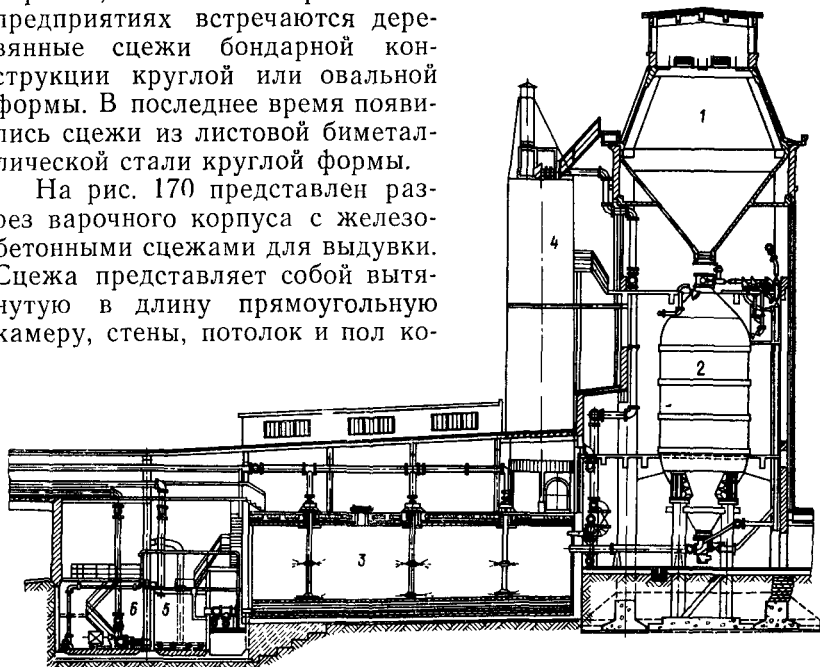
Разрез варочного корпуса со ссечей для выдувки:
